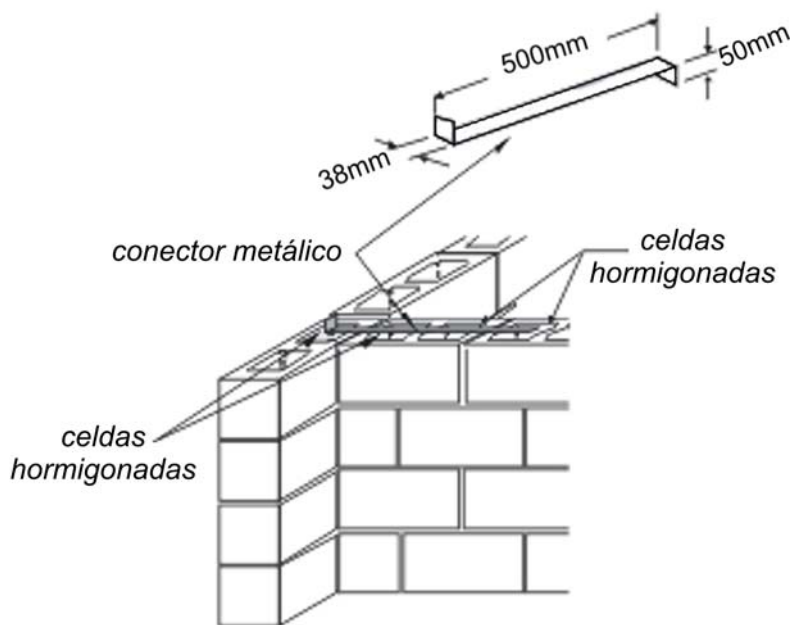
Conector metálico y hormigonado en las intersecciones de muros.
